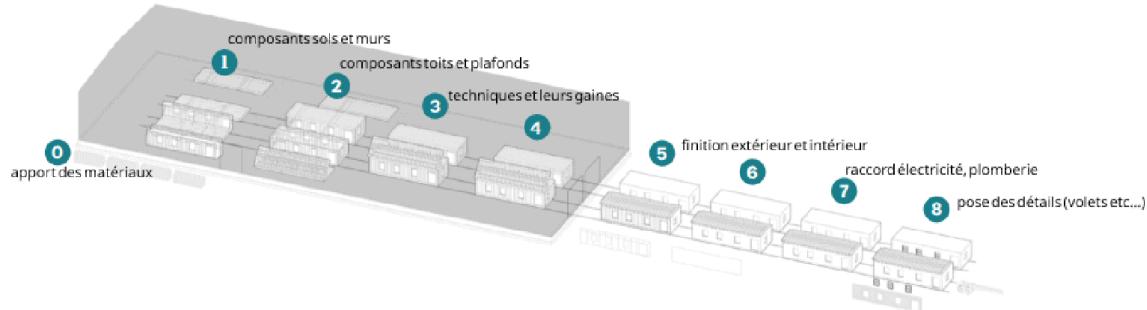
Schéma des différentes étapes d'assemblage d'une construction modulaire hors site (Modular Building Institute (MBI))
